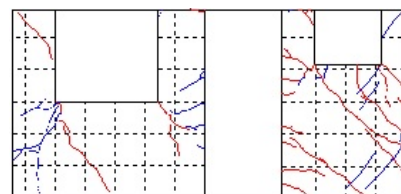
ひび割れ状況(層間変形角2.5/1000rad.)
